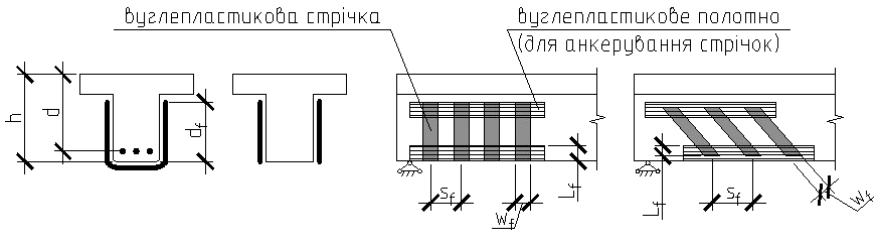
Для розрахунку залізобетонних елементів, підсиленних зовнішньою вуглепластиковою поперечною арматурою
